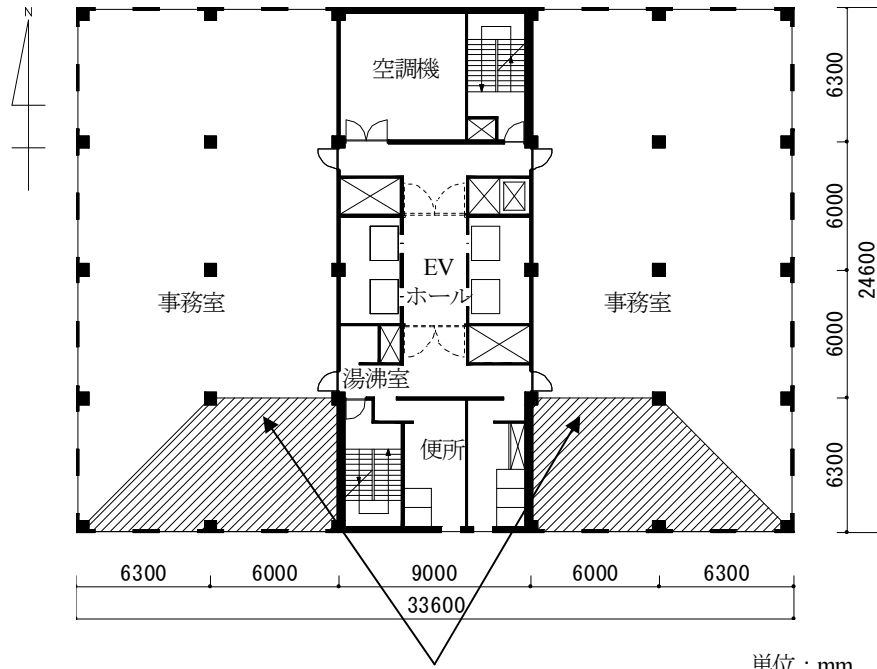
計算用オフィスモデル (平面図) ⁸⁾
